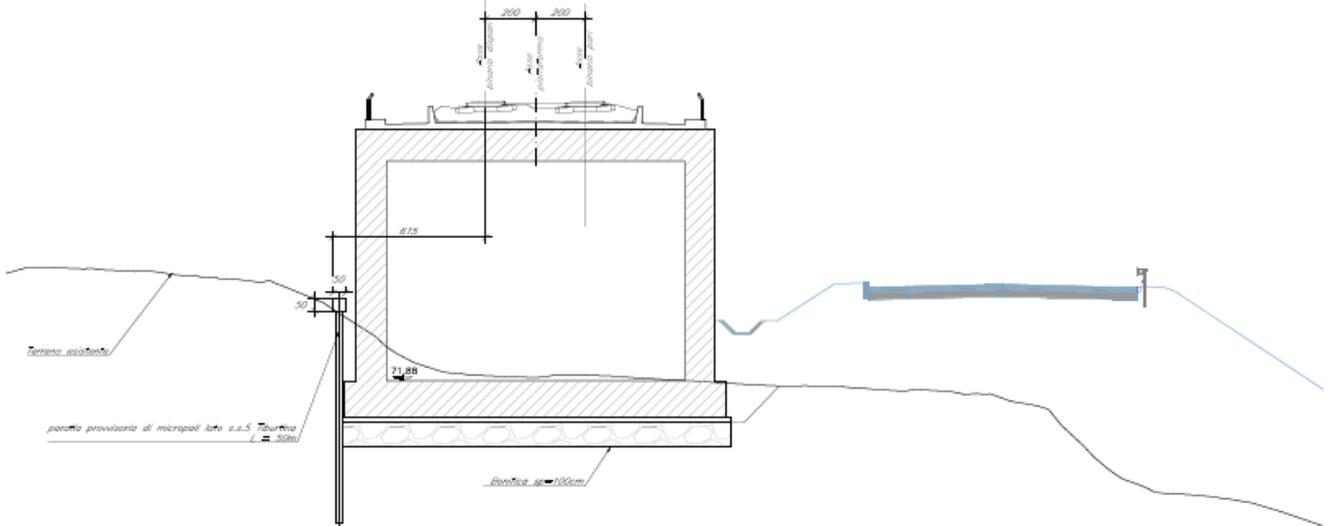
SL21 – Sezione trasversale in asse ferrovia, lato Manoppello
